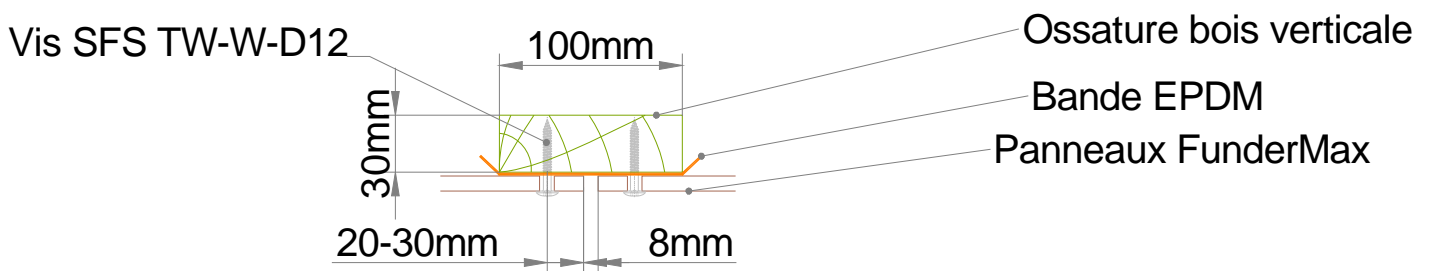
Joint vertical à la jonction de panneaux en vêlage ventilé
